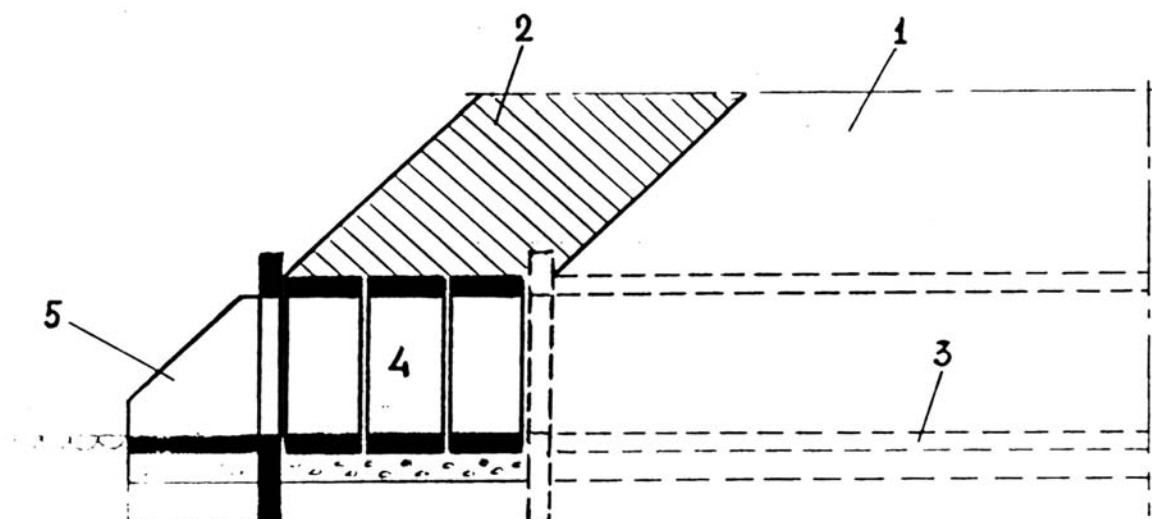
Удлинение круглой трубы: 1 – существующая насыпь; 2 – уширение насыпи; 3 – существующий фундамент; 4 – дополнительные звенья трубы; 5 – новые откосные крылья
